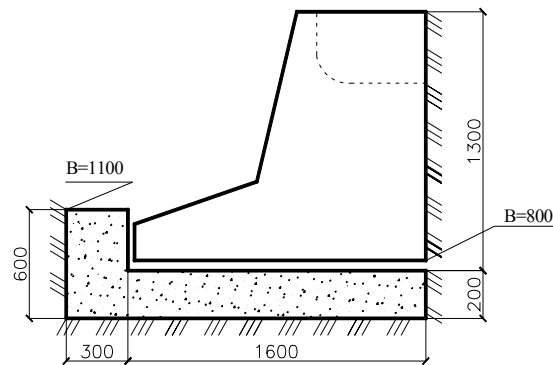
Блочний фундамент з горизонтальною подушкою (Полтавський філіал Укрколгоспроект)
